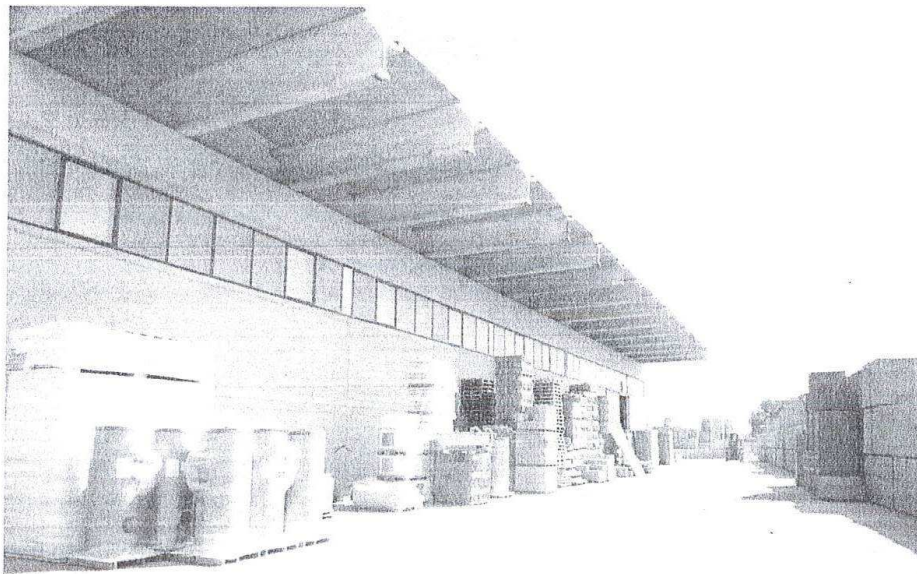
prospetto posteriore con la zona del piazzale adibita allo stoccaggio dei blocchetti di cemento prodotti.
